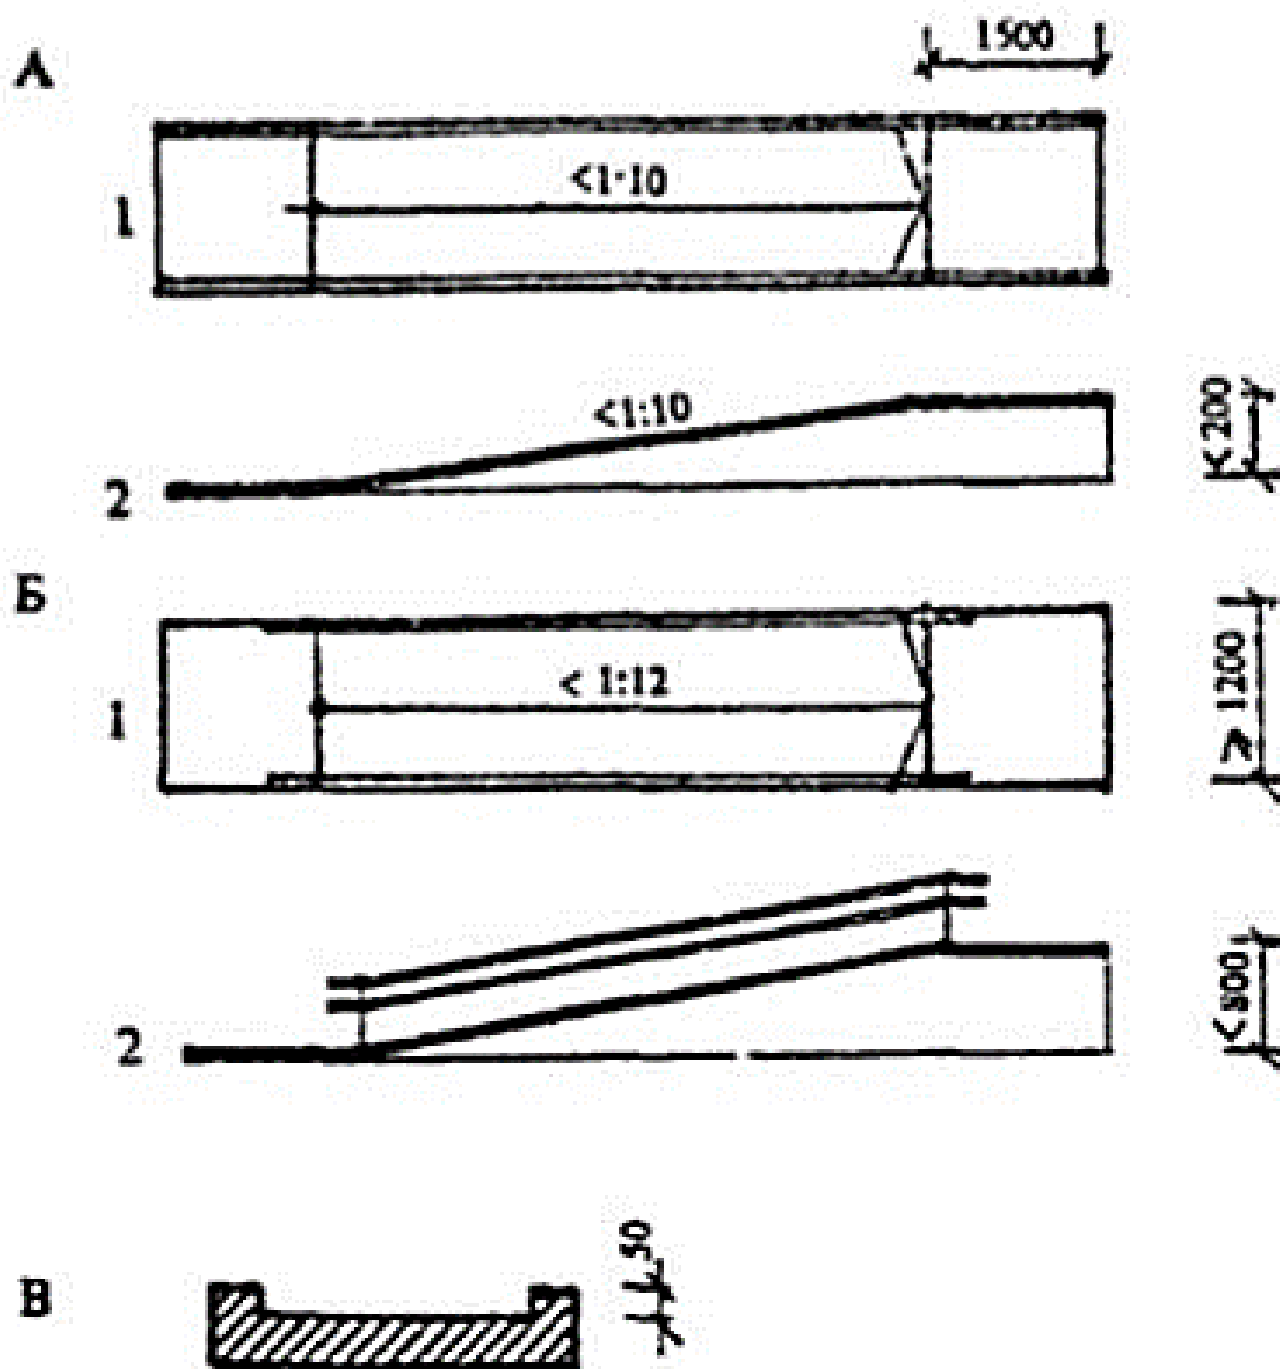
Пандусы: А – на высоту до 0,2 м; Б – на высоту до 0,8 м; В – поперечный профиль пандуса: 1 – план, 2 – разрез
